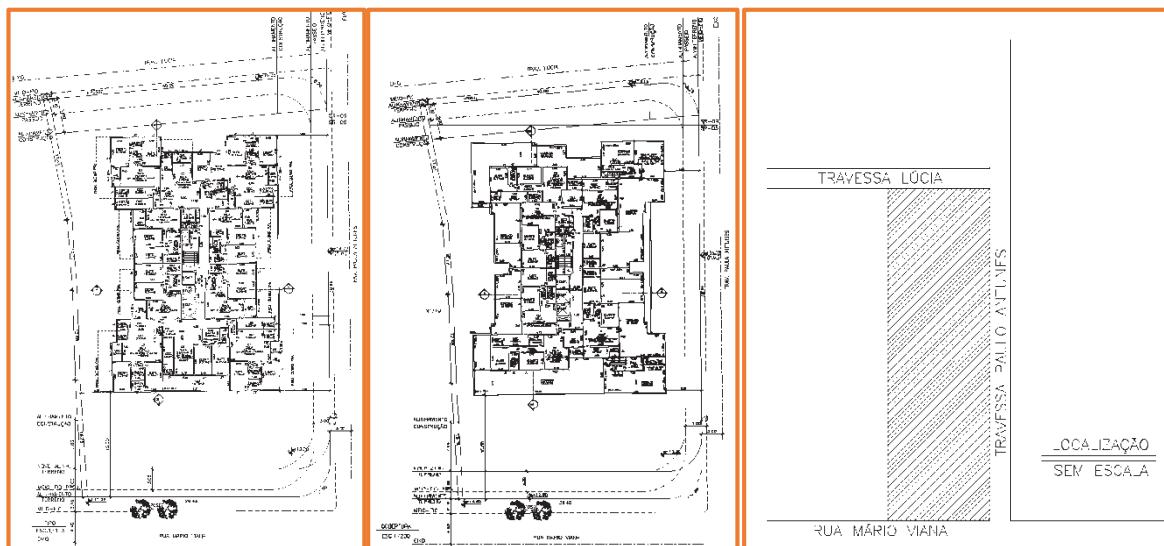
Pavimento Tipo, Cobertura e Localização - Fonte: Projeto Legal
